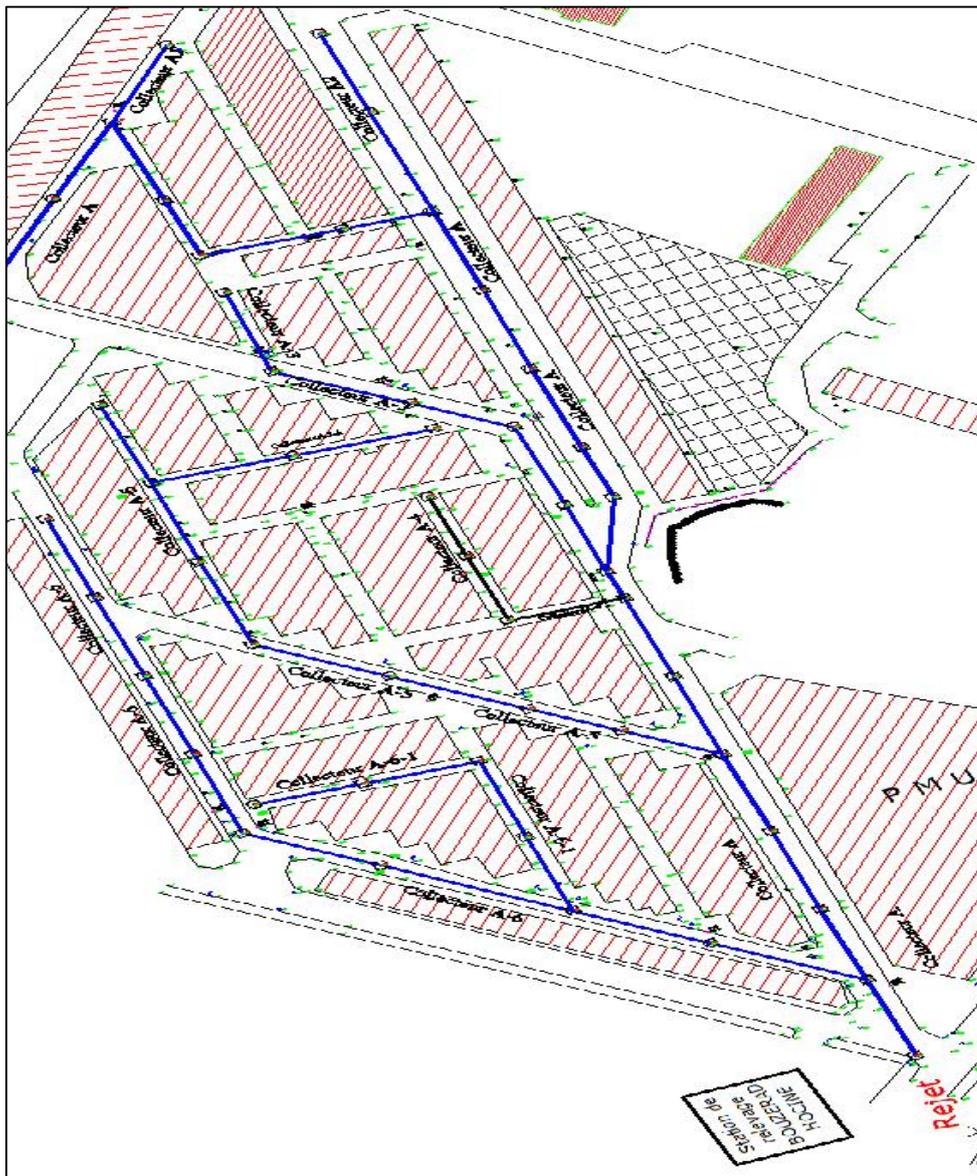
Tracé en plan du réseau d'assainissement projeté pour le quartier d'Oued d'hebbII
